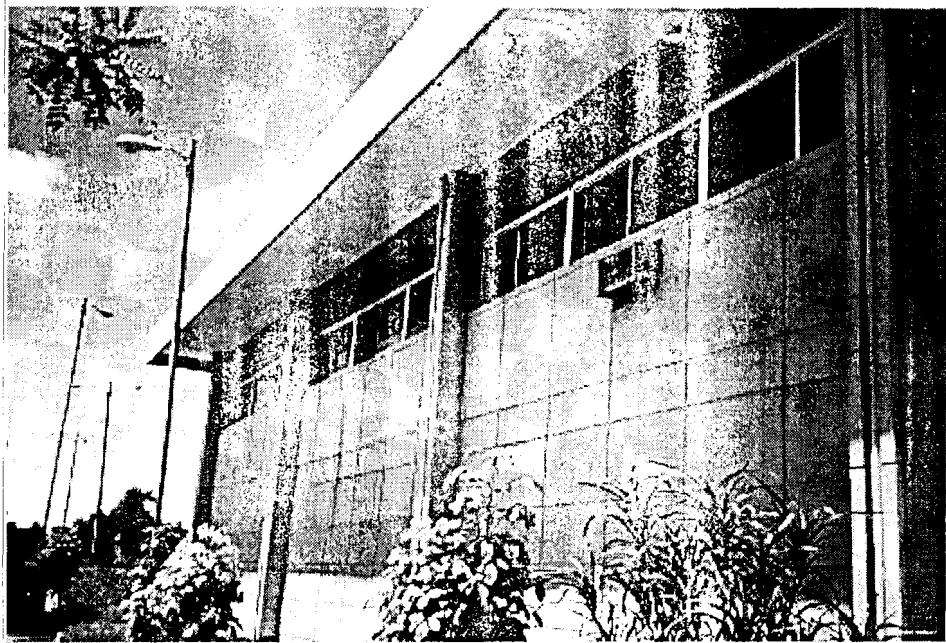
Laboratorios F.I.C.T.:* Suelos y Rocas: cielo raso enlucido. Pintura en mal estado por filtración en losa de cubierta.
